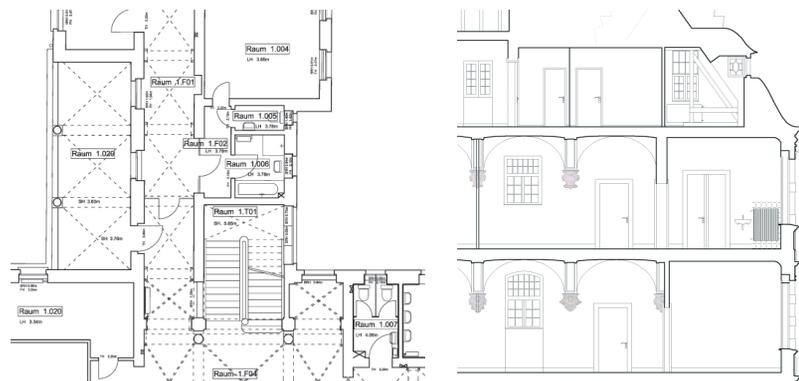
Bestandserfassung in Grundriss und Schnitt
